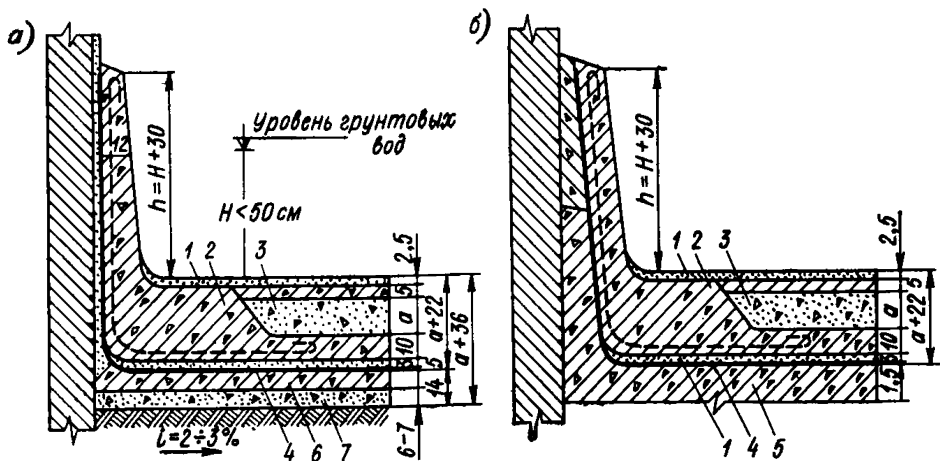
Гидроизоляция из рулонных материалов при уровне грунтовых вод до 50 см
